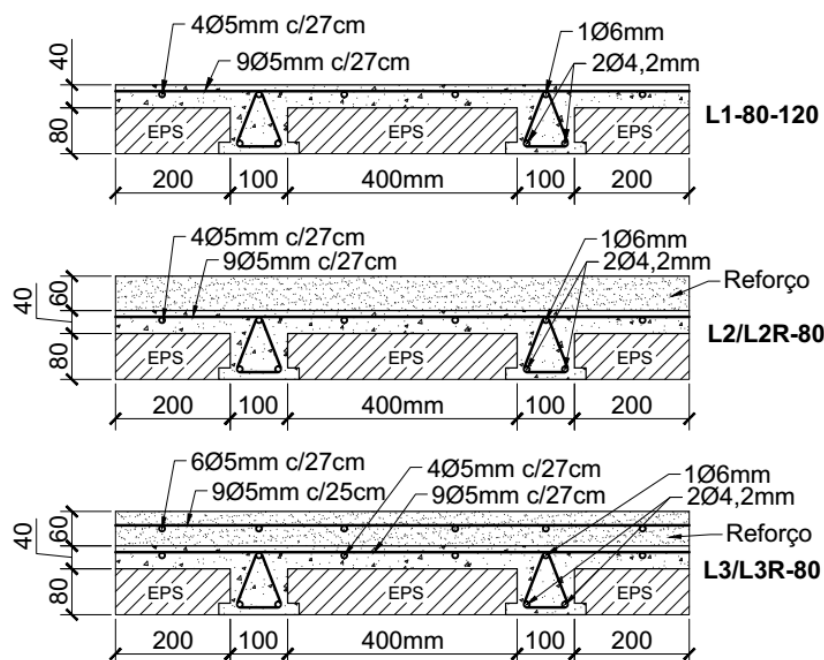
Detalhamento das lajes ensaiadas (COSTA, 2006).
